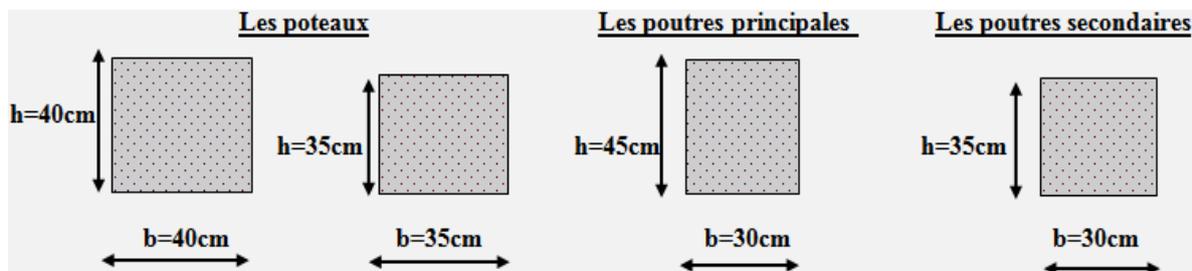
le coffrage obtenu pour les différent section poteaux ; poutre
